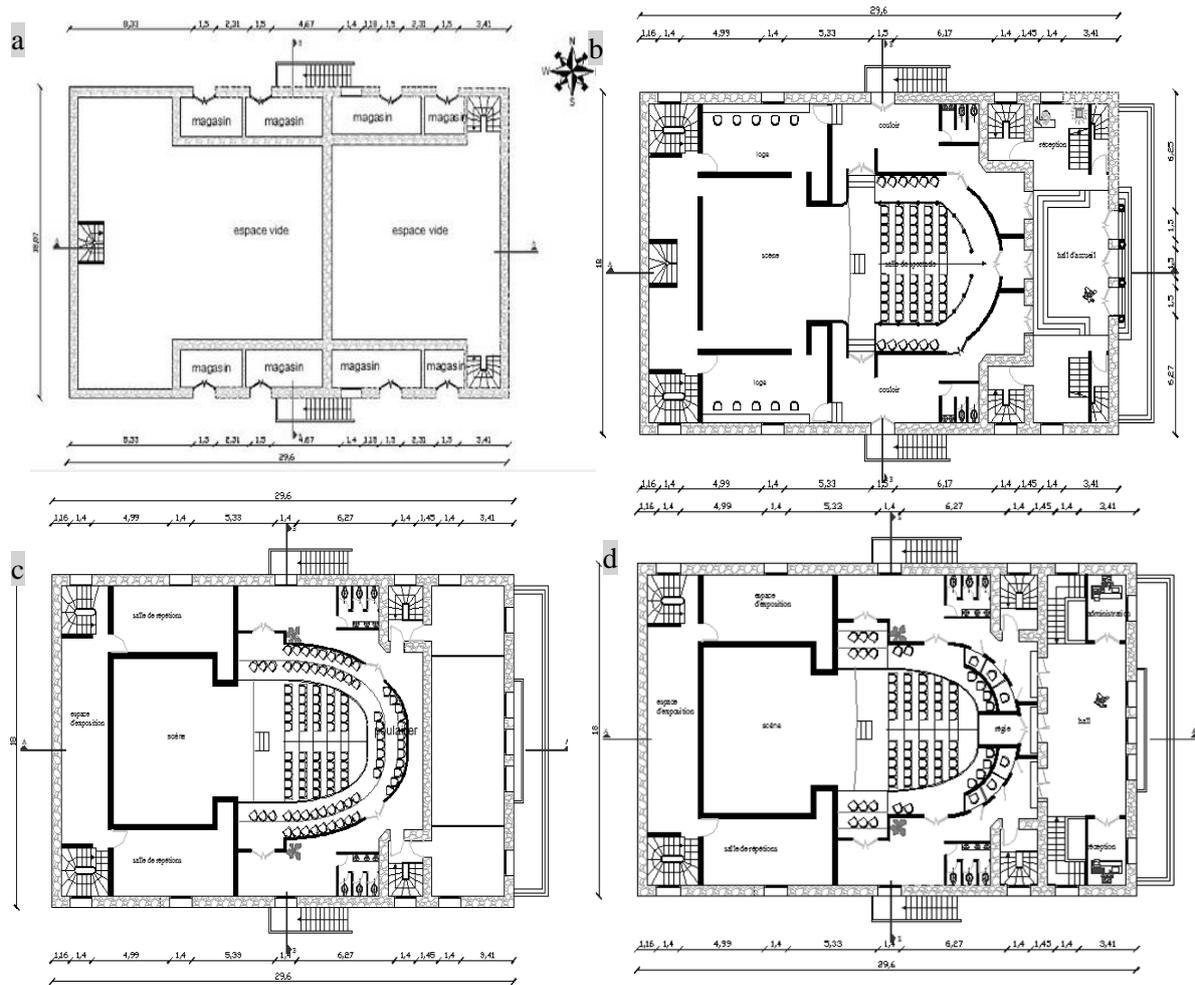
a) plan du sous-sol ; b) plan du RDC ; c) plan du R+1 ; d) plan du R+2.
